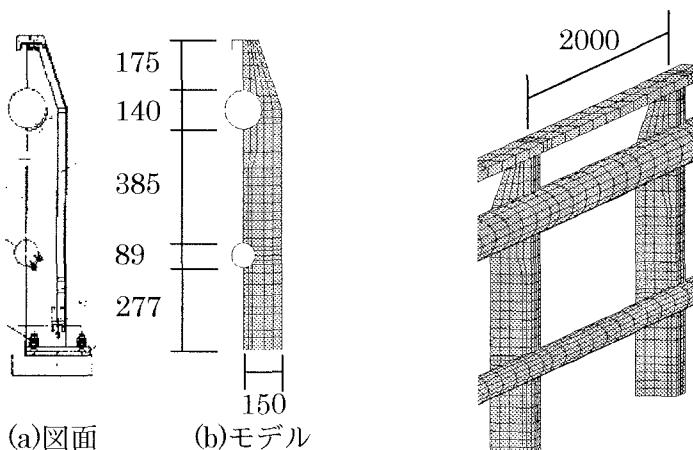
支柱断面比較(単位: mm) 図-3 モデル斜視図(単位: mm)
